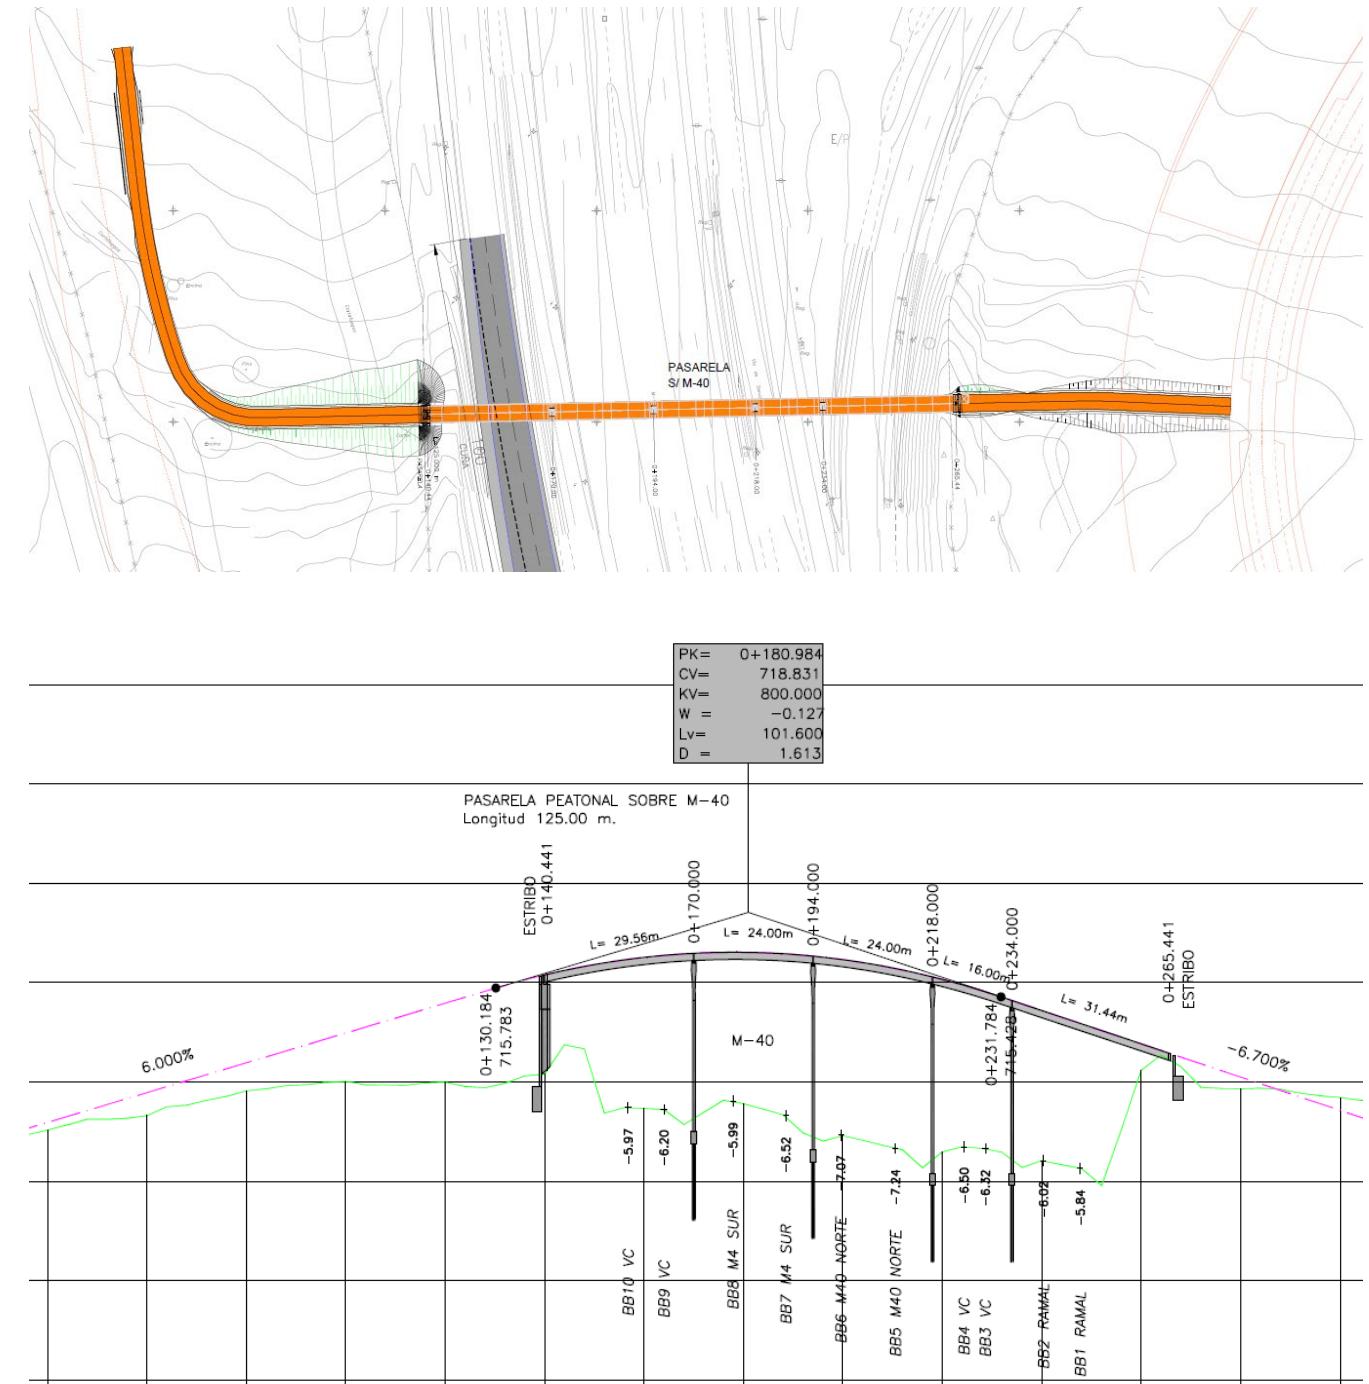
Perfil longitudinal ESTRUCTURA 8
